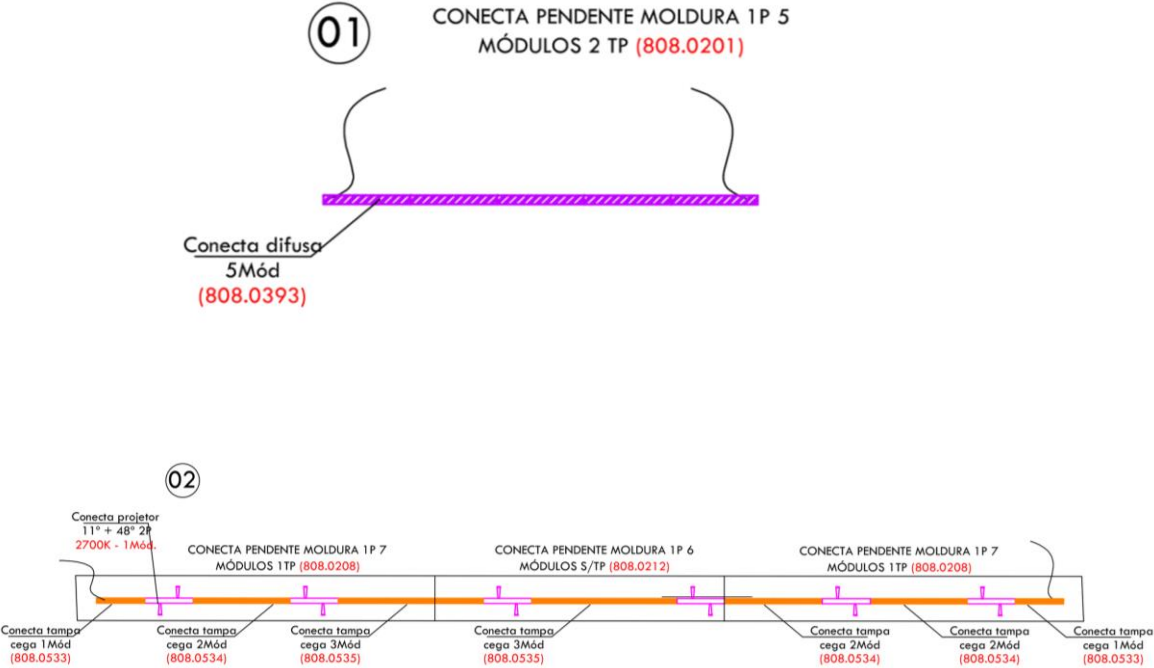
Planta de iluminação | Piso 1. Fonte: 2L'atelier
